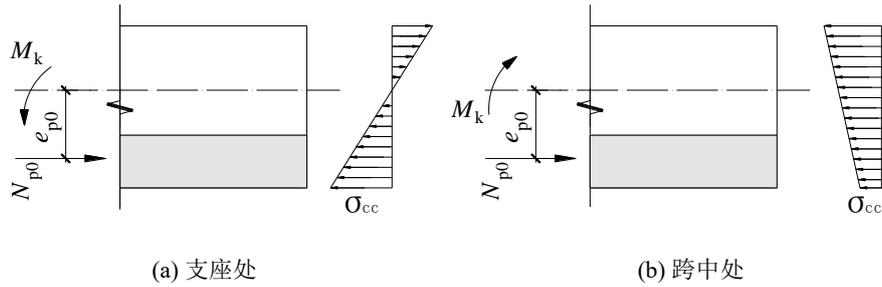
钢管桁架预应力混凝土预制底板截面边缘混凝土法向压应力示意
